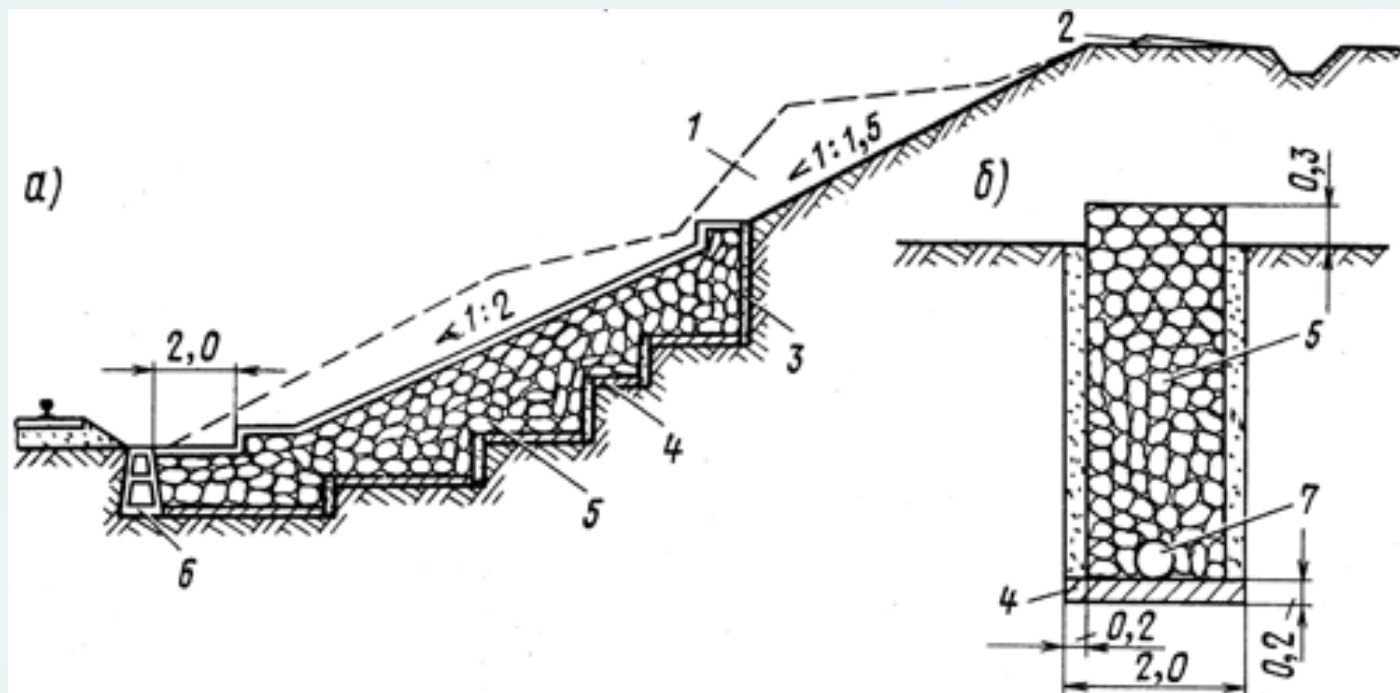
Контрфорс в откосе выемки: а – продольный; б – поперечный разрезы; 1 – грунт, срезаемый для уположения откоса; 2 – банкет; 3 – крупнозернистый песок; 4 – бетон; 5 – сухая кладка; 6 – железобетонный лоток; 7 – дренажная труба
